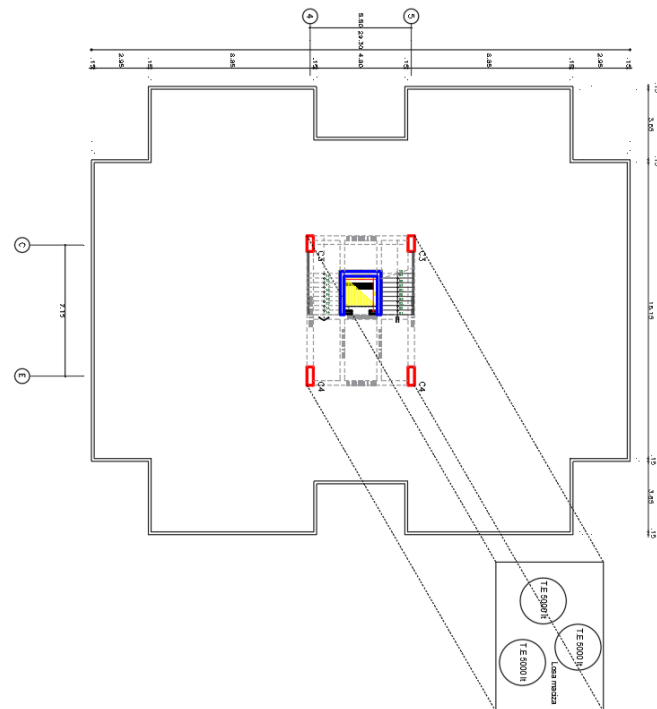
Vista en planta de la arquitectura del edificio – azotea
